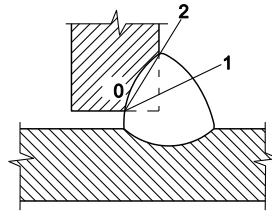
Схема расчетных сечений сварного углового шва при расчете на срез
